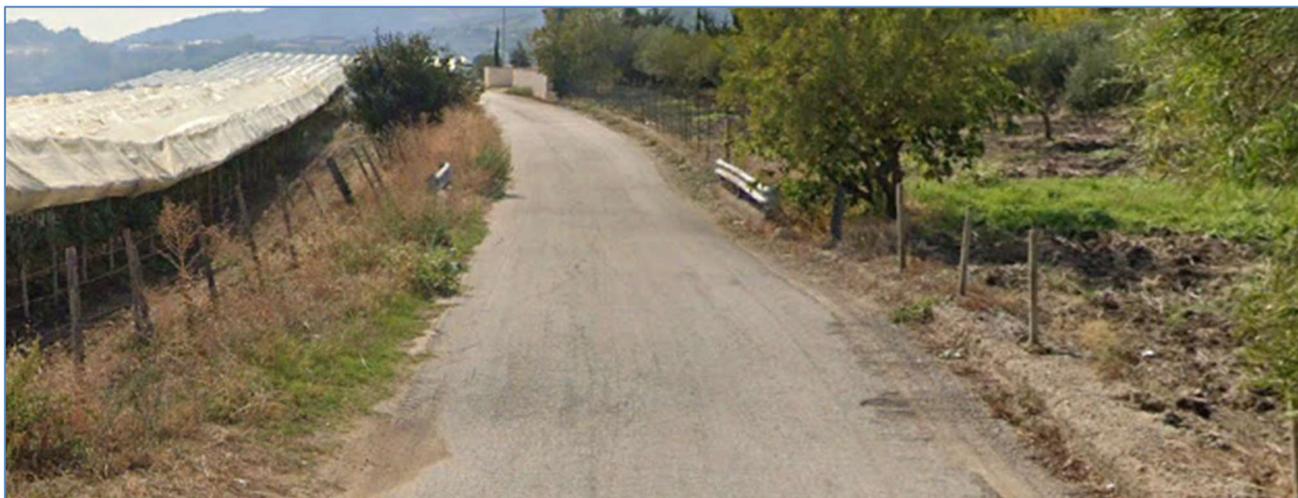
Strada Vicinale interessata dalla posa dell'elettrodotta di connessione alla rete
